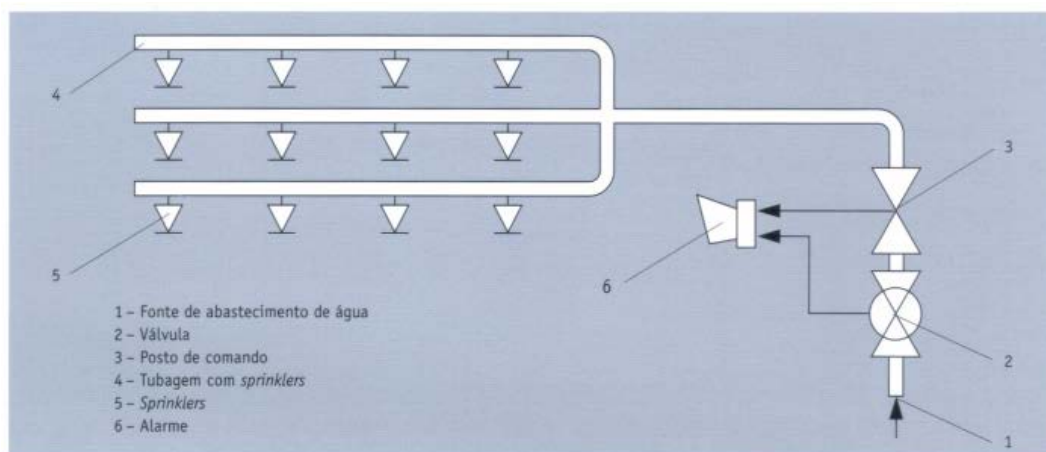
Esquema de um sistema de sprinklers [4].
